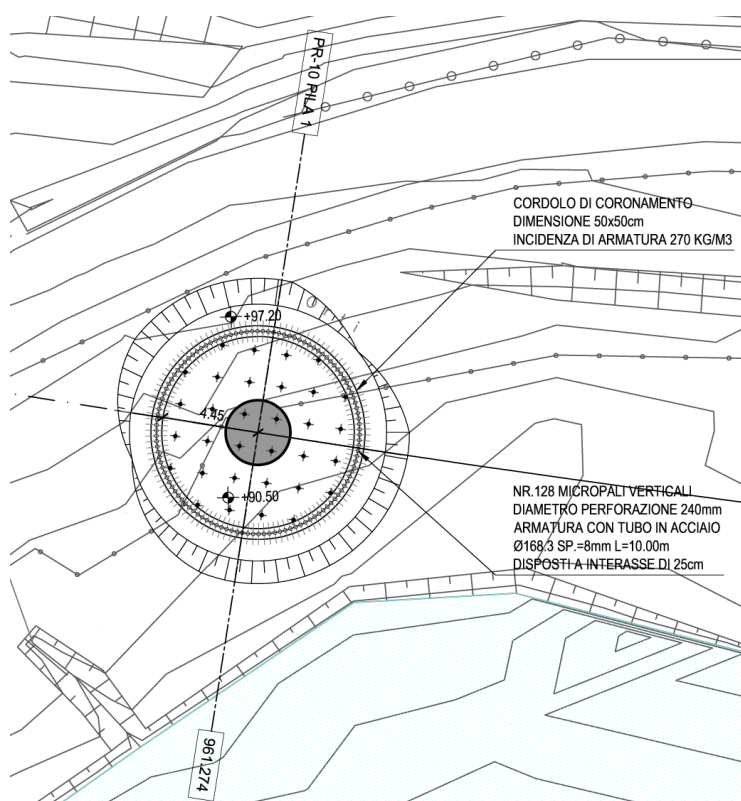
Stralcio planimetrico opera provvisoria pila 1.
